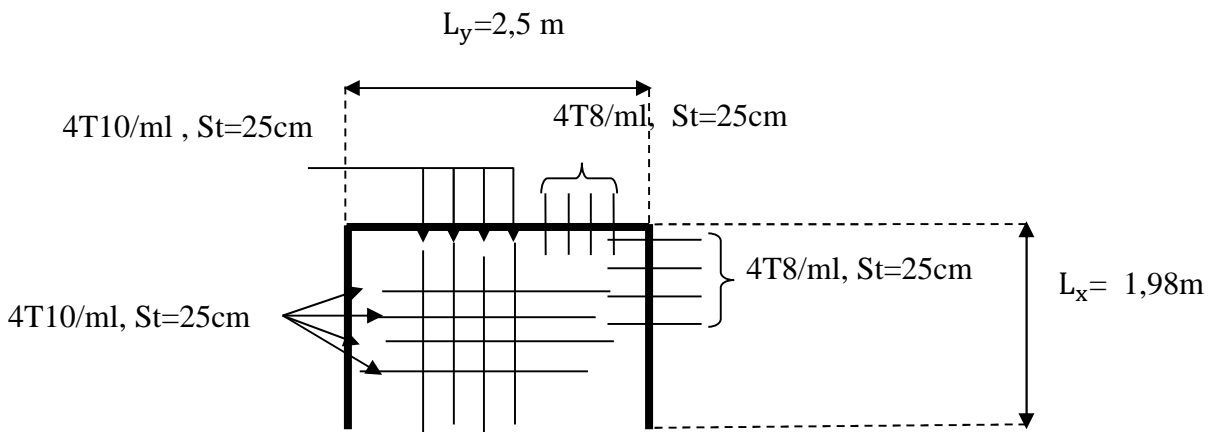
Schéma de ferrailage de la dalle Type 02
